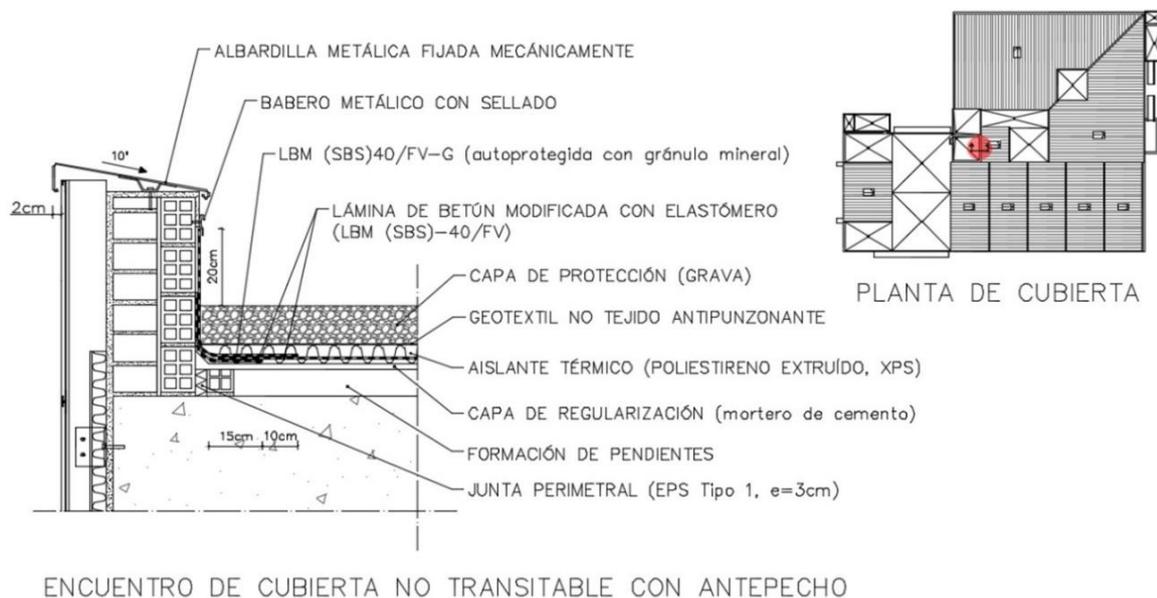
Esquema de cubierta plana no transitable en su encuentro con el antepecho perimetral.
